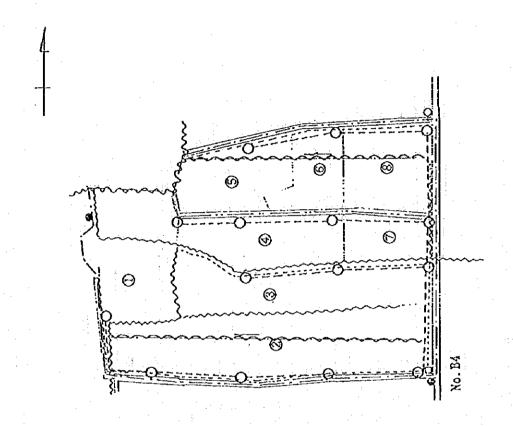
Plan horizontal du projet des installations terminales (Atilet)
